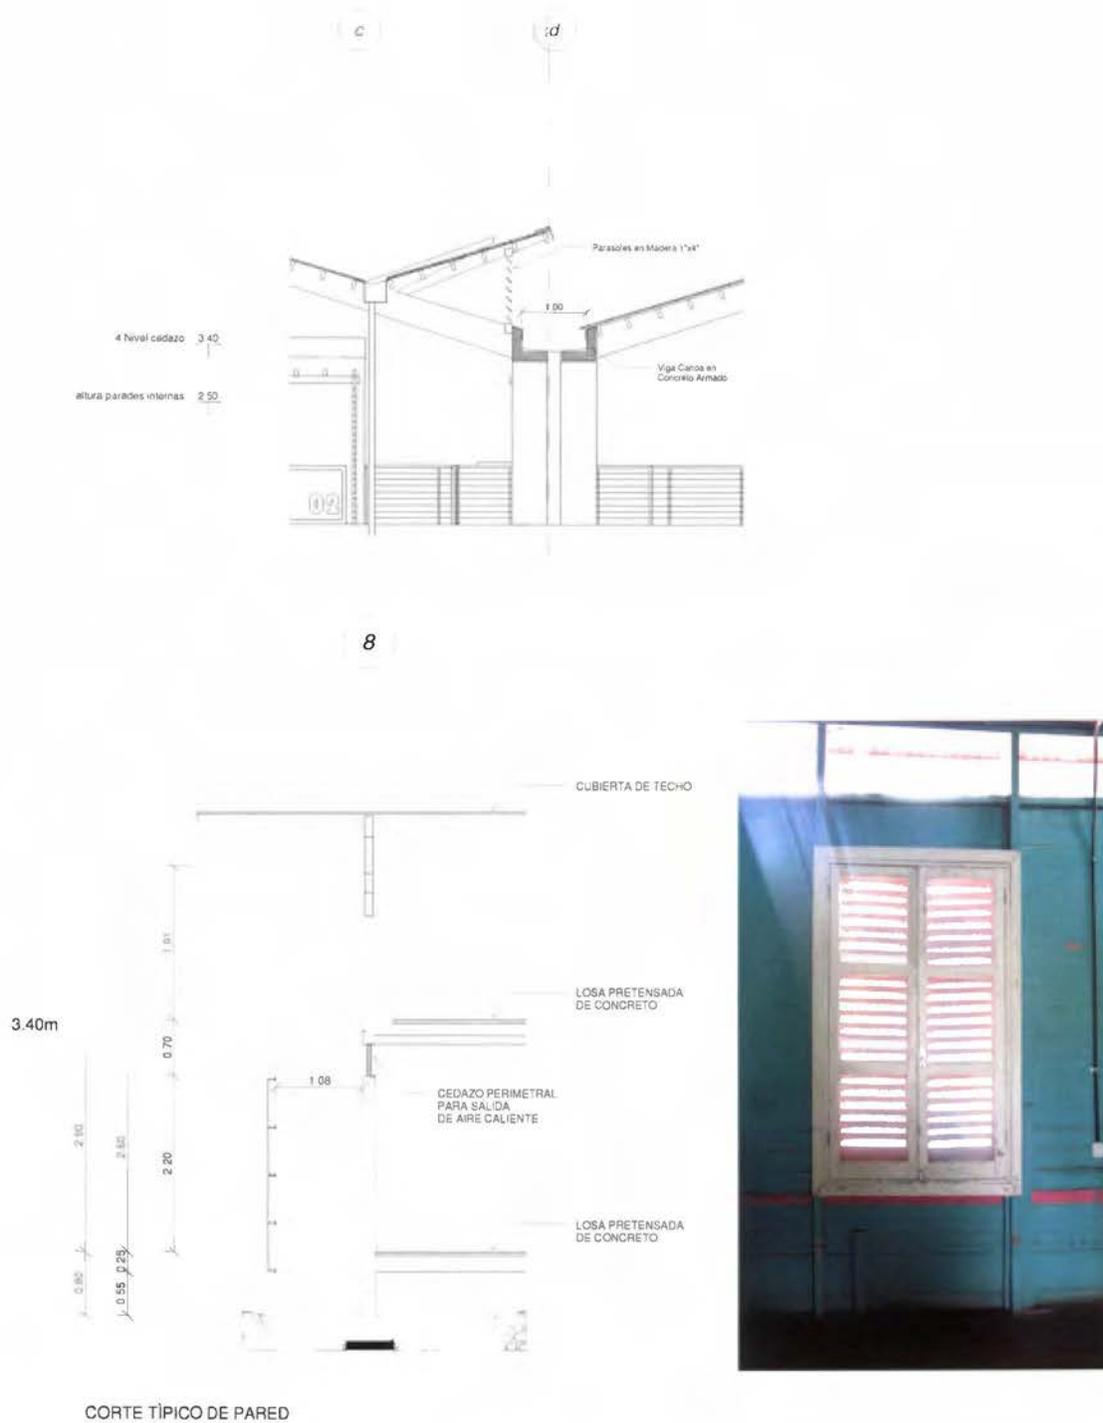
Detalles arquitectónicos. Elaborados por la autora.
